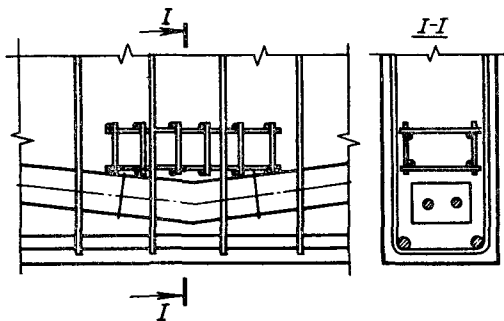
Усиление бетона дополнительным армированием в местах перегиба напрягаемой арматуры.
